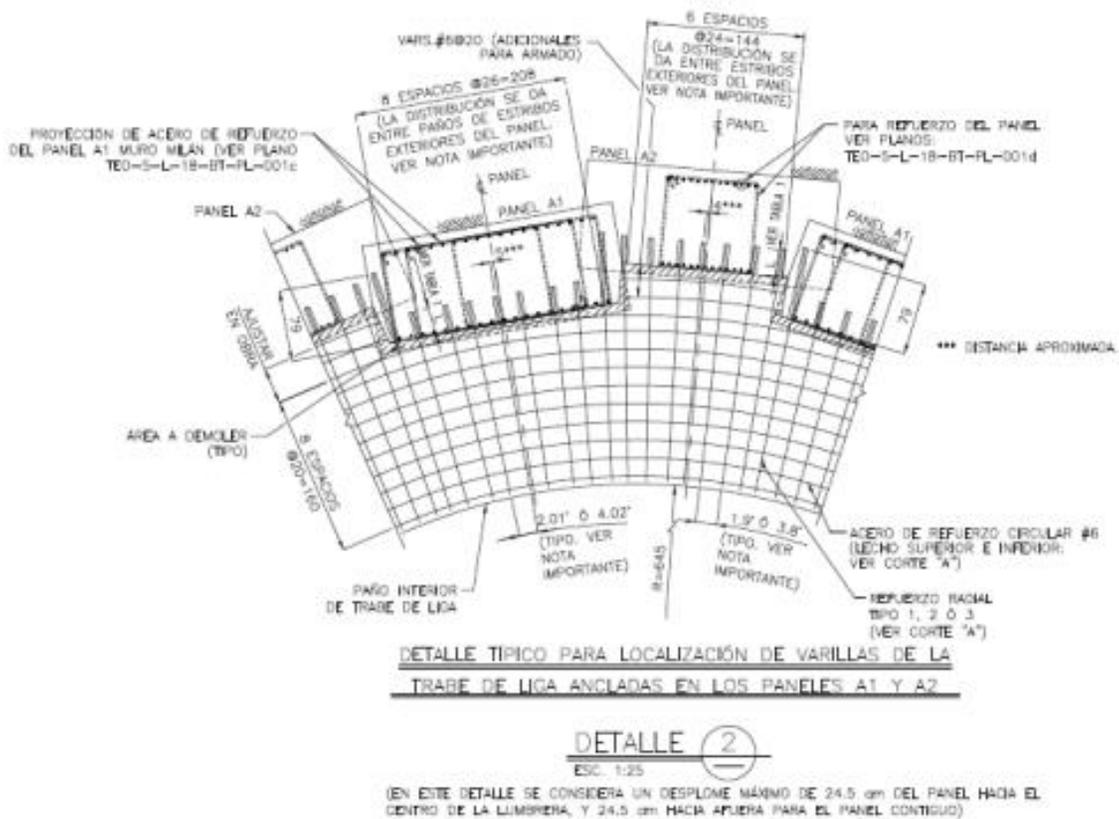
29 Detalle de localización de las varillas en trabe de liga
